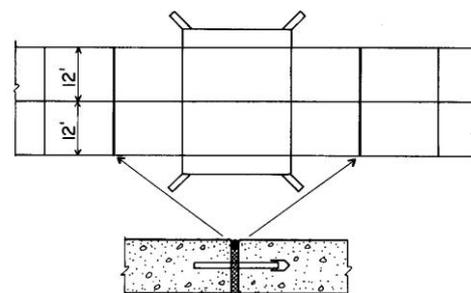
Exemple de joints de dilatation protégeant un passage inférieur (PI) sur route ou autoroute
